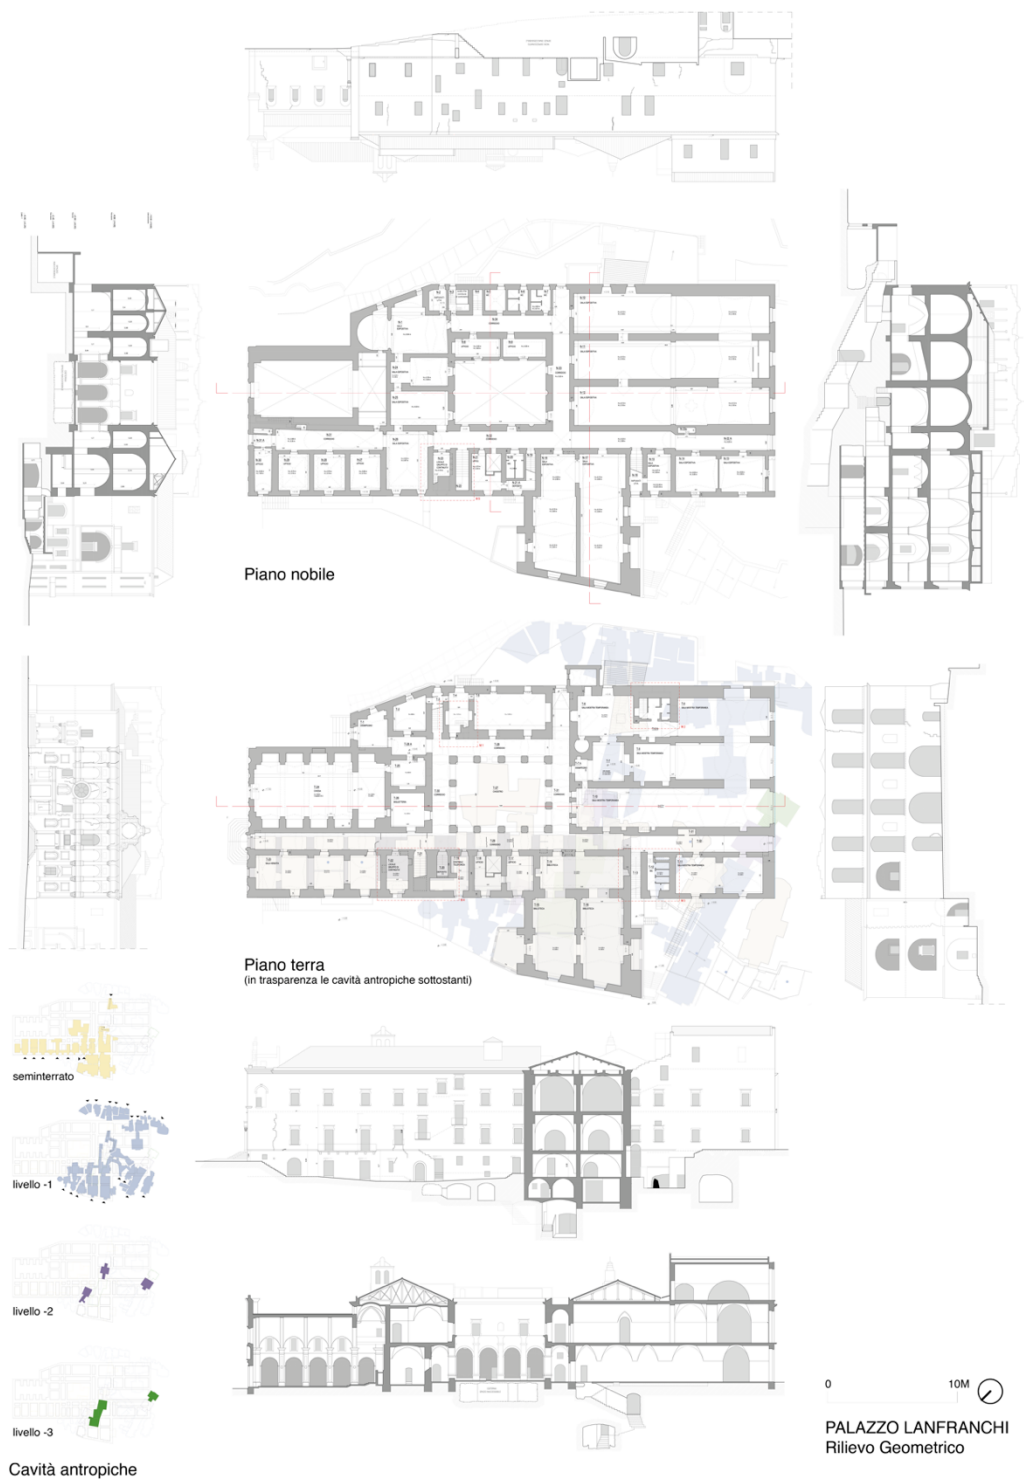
Rilievo geometrico: piante, prospetti, sezioni, cavità antropiche.
